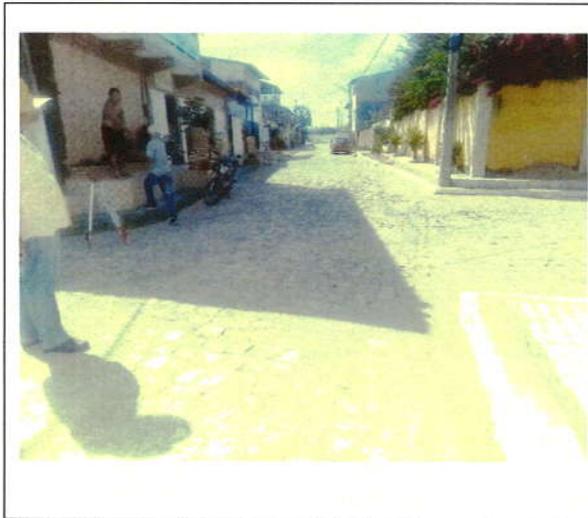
Trecho onde será implantado o sistema de drenagem da Vila Isaura.
